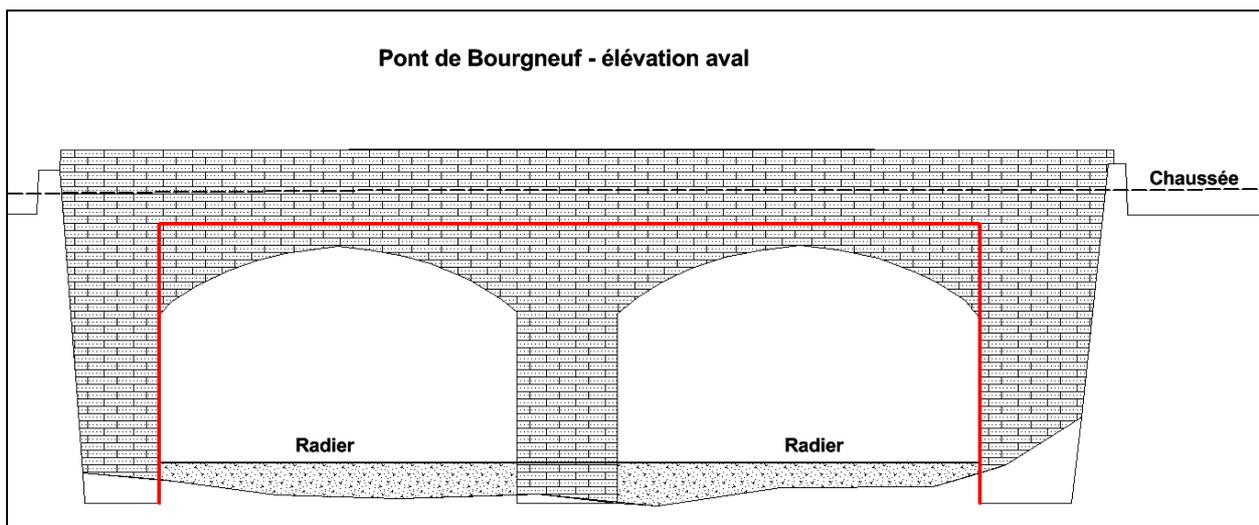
application au cas du pont de Bourgneuf – pont cadre.
